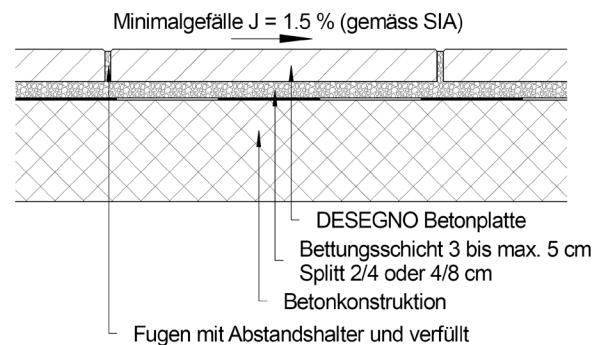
Schematische Darstellung des Aufbaus der Betonplatten auf eine starre Betonkonstruktion ohne Isolationschicht mit einer Bettungsschicht
